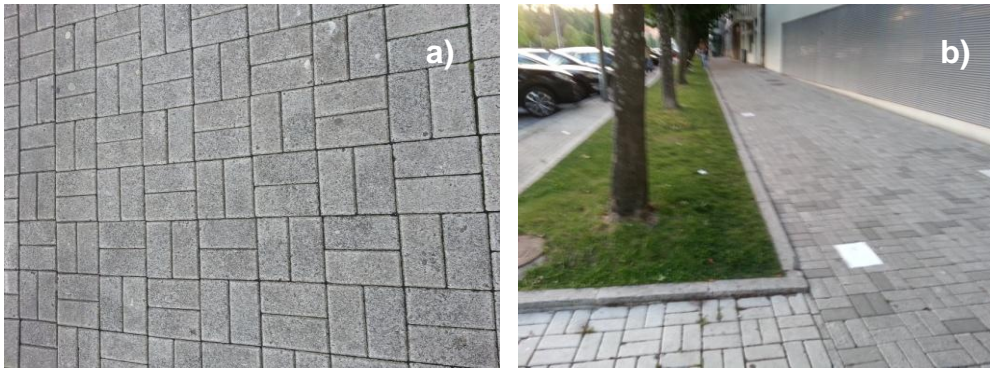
a) Padrão de assentamento, b) Diferença entre as lajetas pré-fabricadas de Betão
